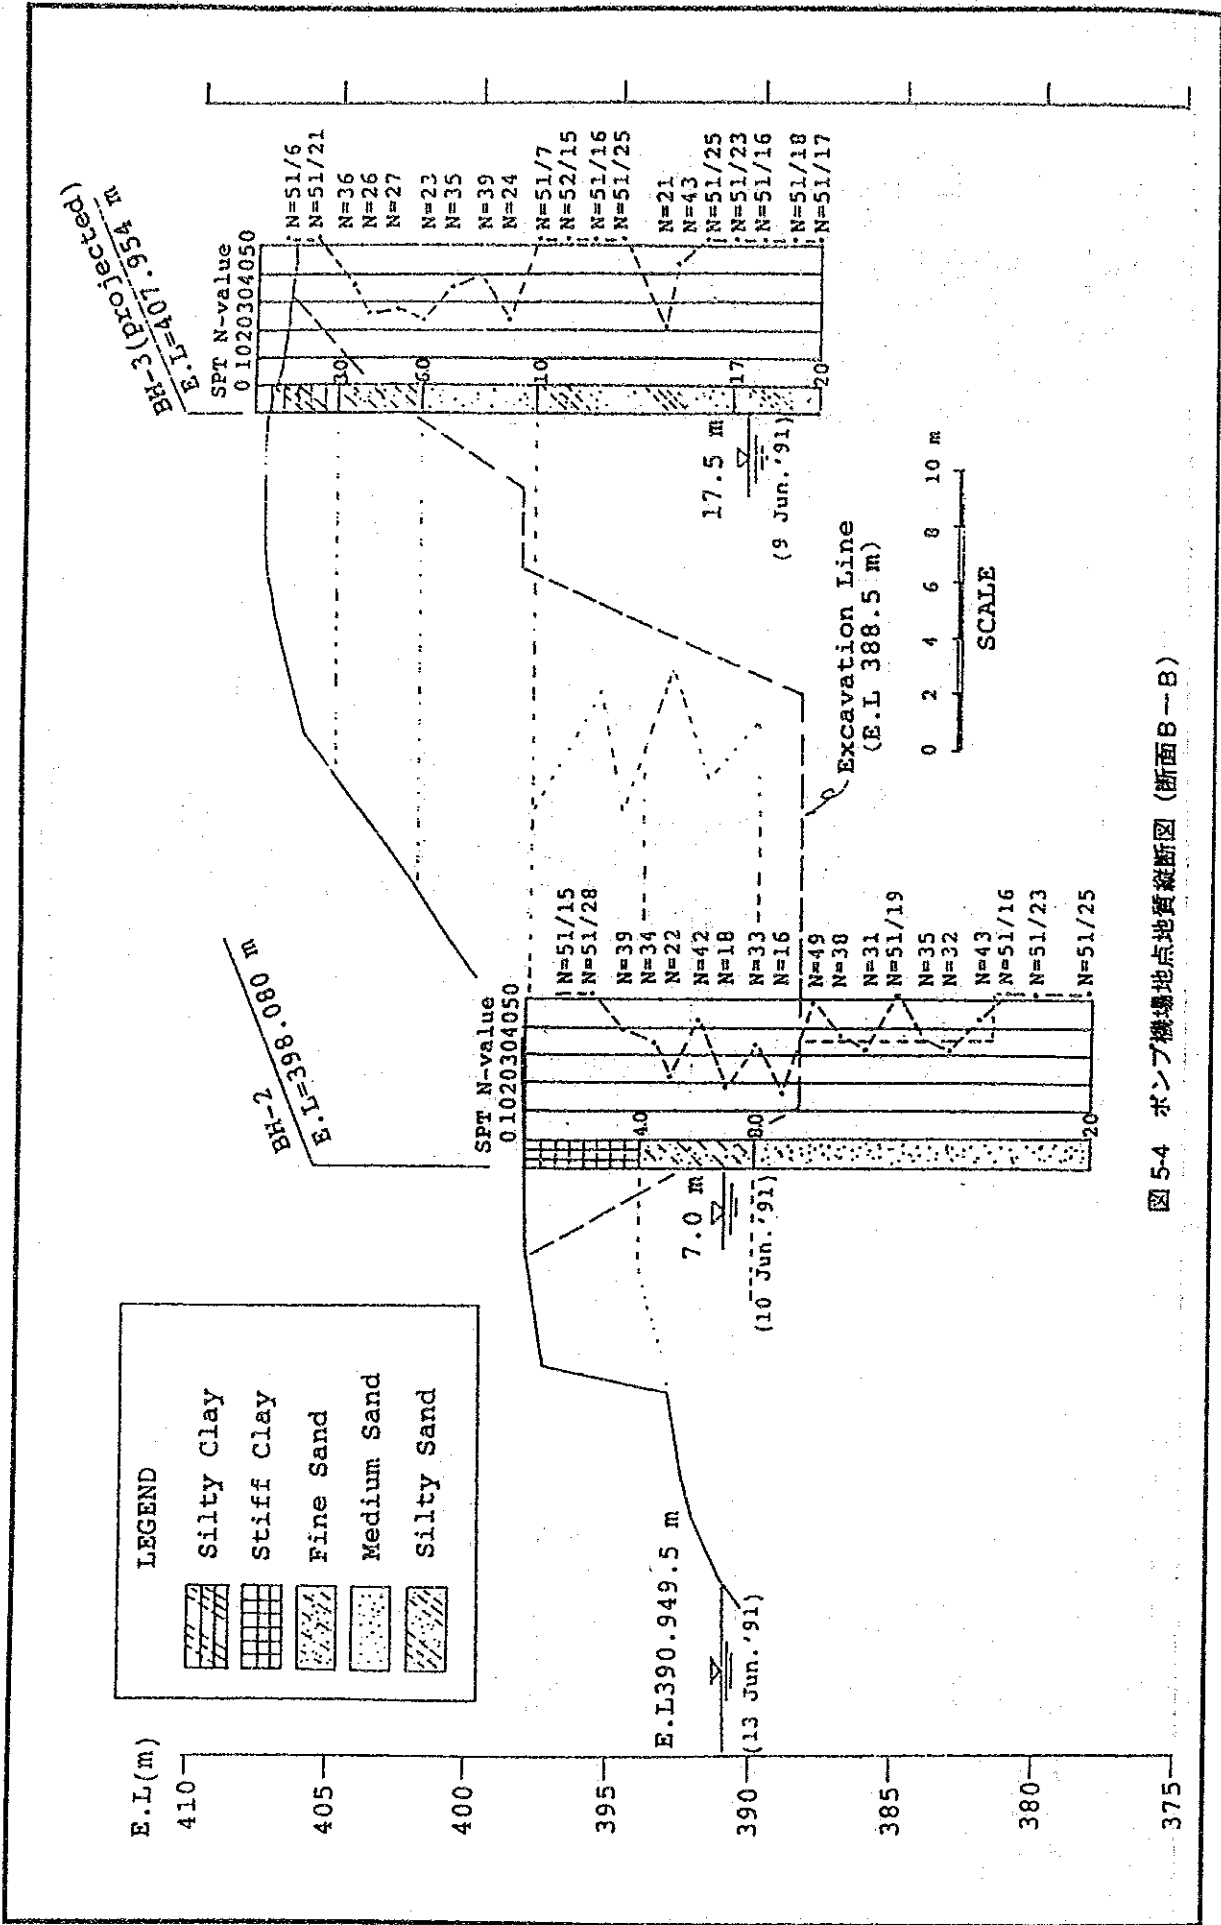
ポンプ機場地点地質縦断面図 (断面B-B)
